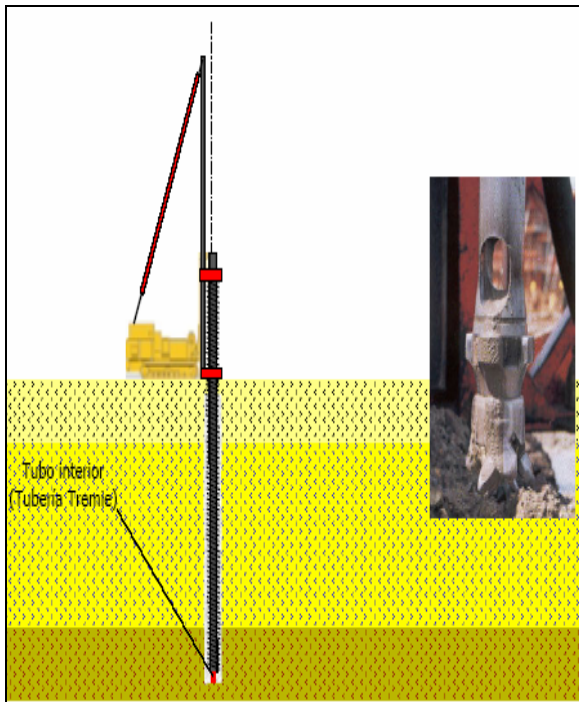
Levantamiento de la herramienta de corte y colocación de tubería en posición
